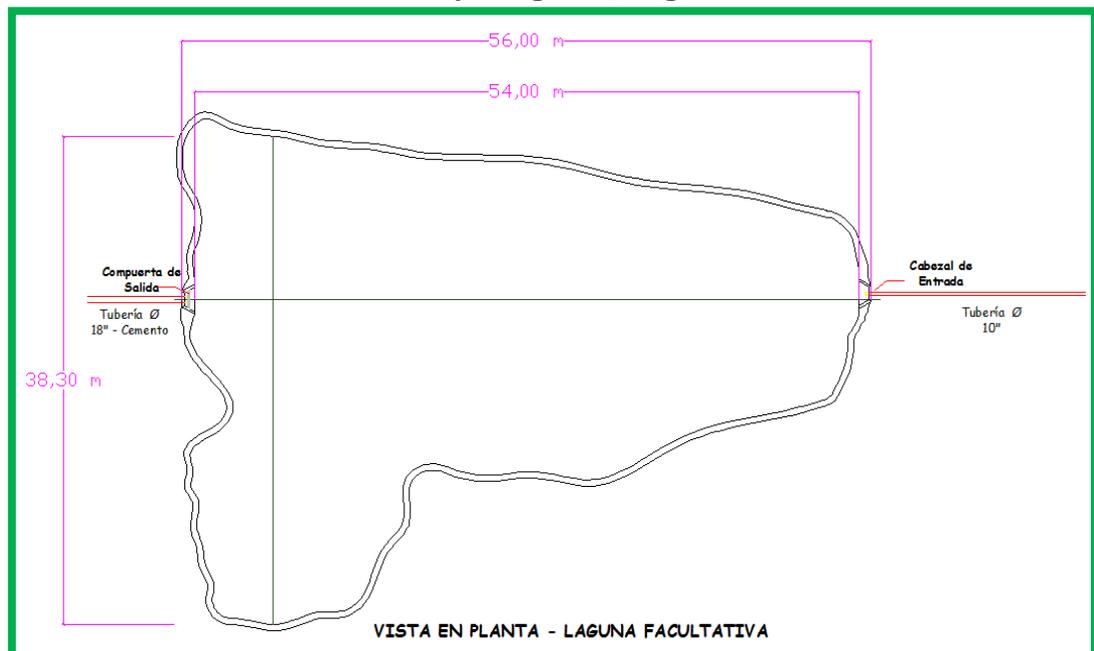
Vista en Planta – Ancho y longitud, Laguna facultativa
